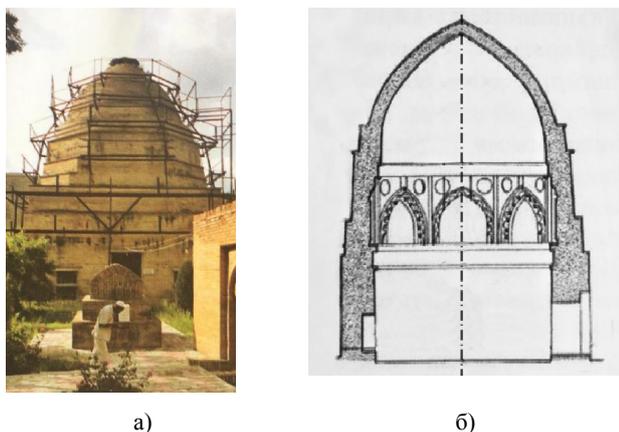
Внешний вид (а) и схема-разрез (б) мавзолея Шах-Фазиль [2].
